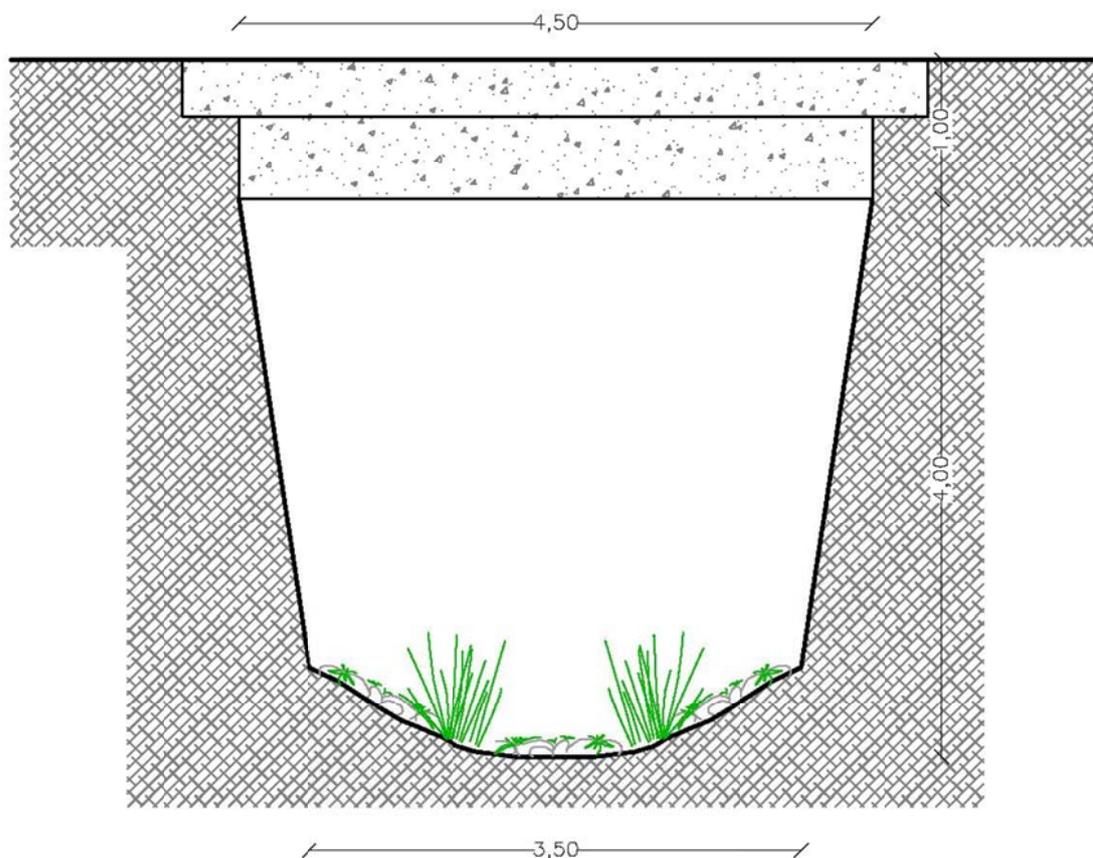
sezione trasversale a monte dell'attraversamento stradale
